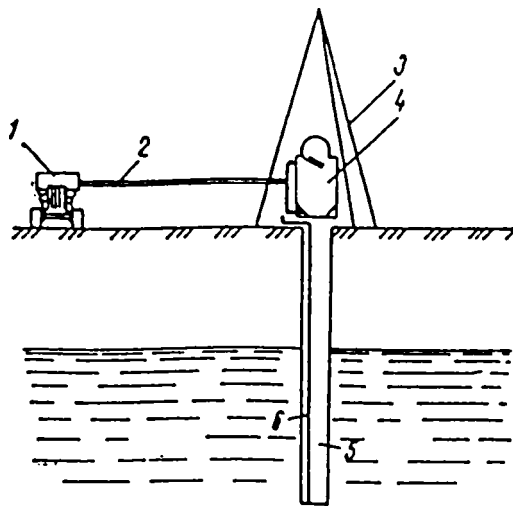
Schema instalației pentru executarea piloților Wolfholtz:
